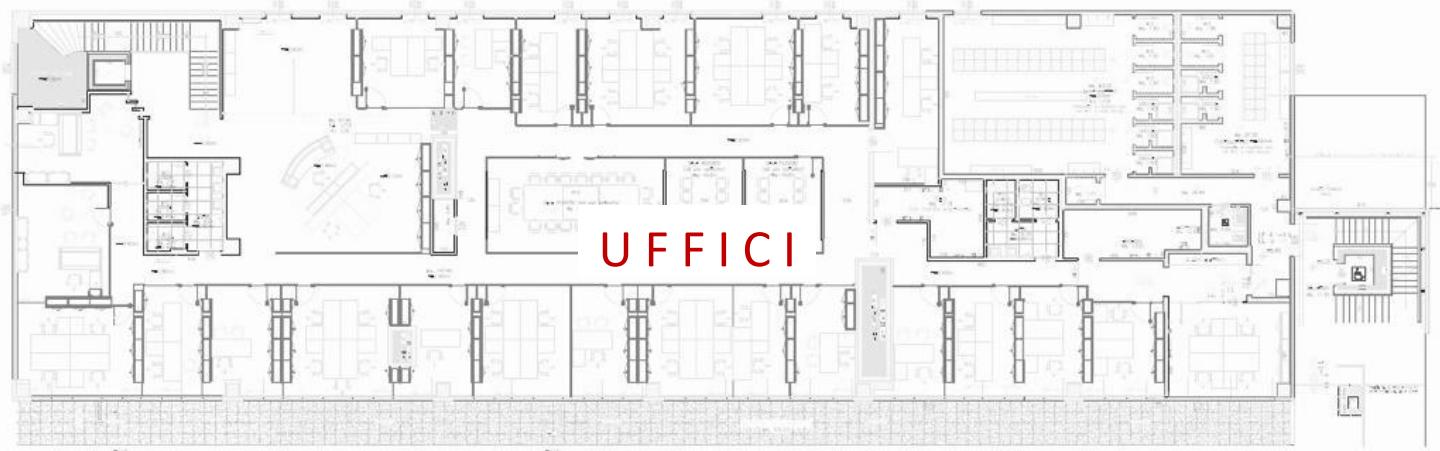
Sito via della Punta 21-23 - Planimetria primo piano: uffici
